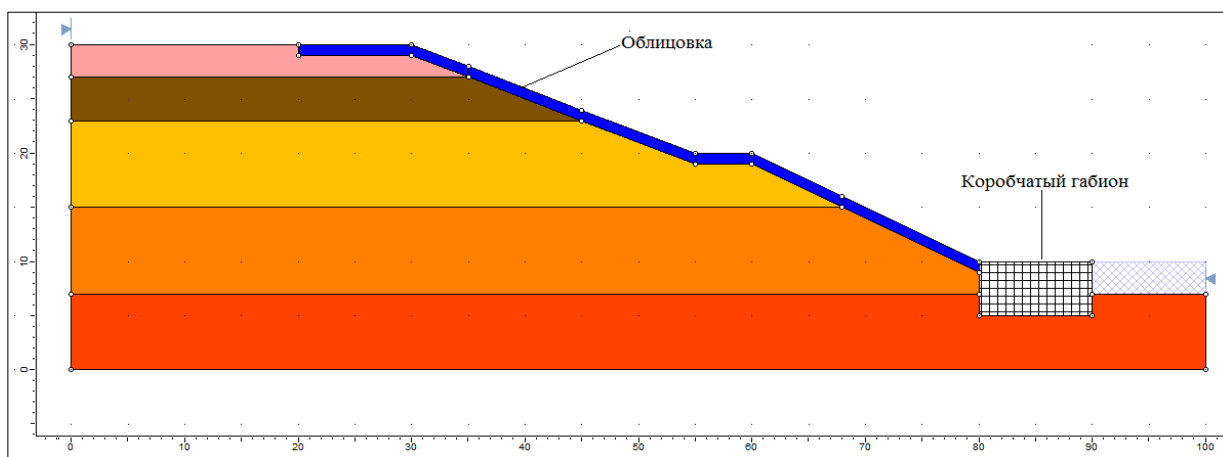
Схема укрепления склона берега р. Красной с помощью габионов и железобетонной облицовки
